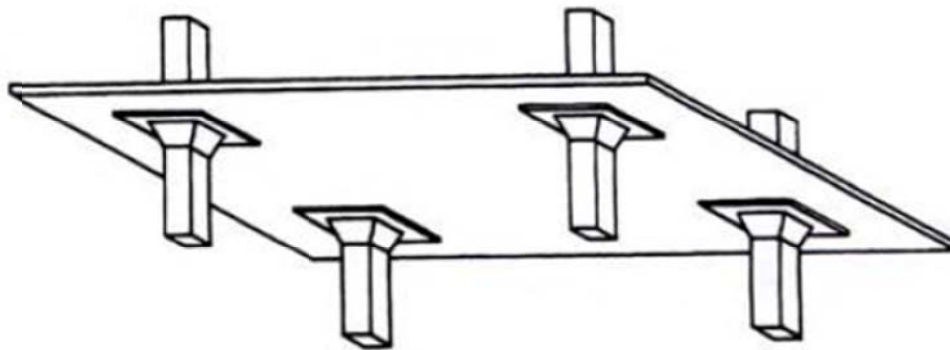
Laje cogumelo, *Reinforced Concrete Slabs* [10].
